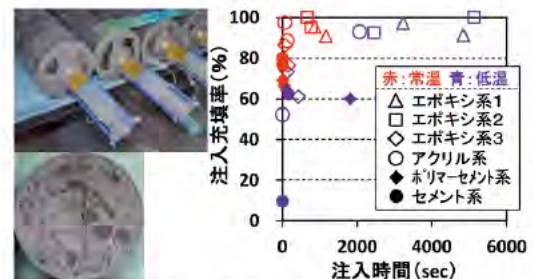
施工時低温環境とひび割れ注入充填性に関する検討
